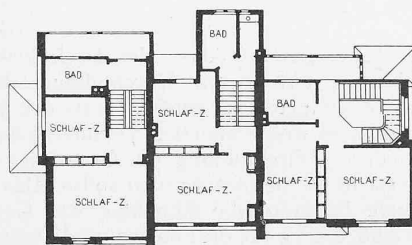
Grundriss vom Dachgeschoss der Häusergruppe. Masstab 1 : 400.
